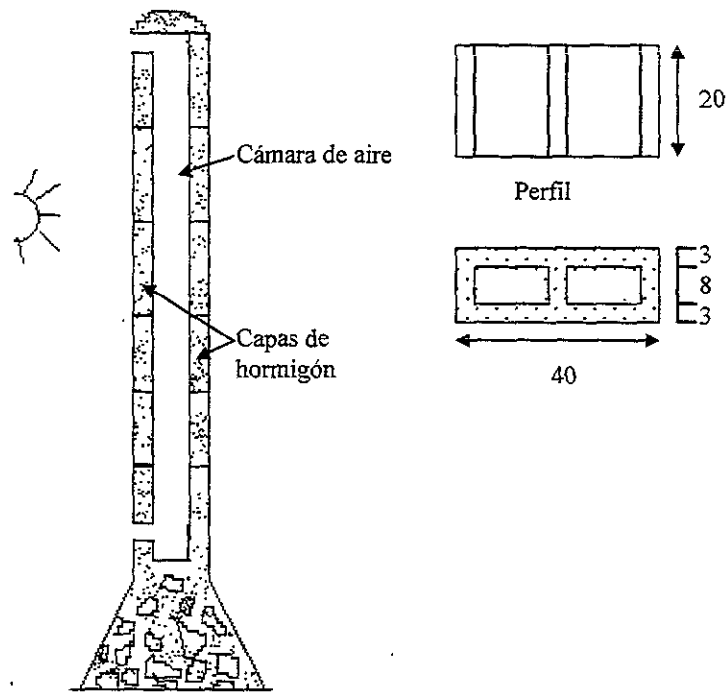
MURO DE LA FACHADA PONIENTE CONSTRUIDO CON BLOCK HUECO.
